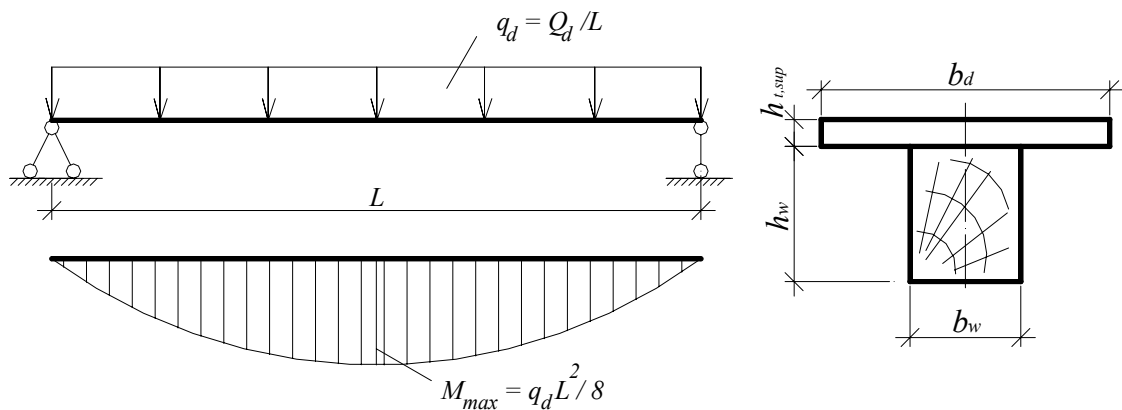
Расчетная схема плиты, расчетное поперечное сечение
